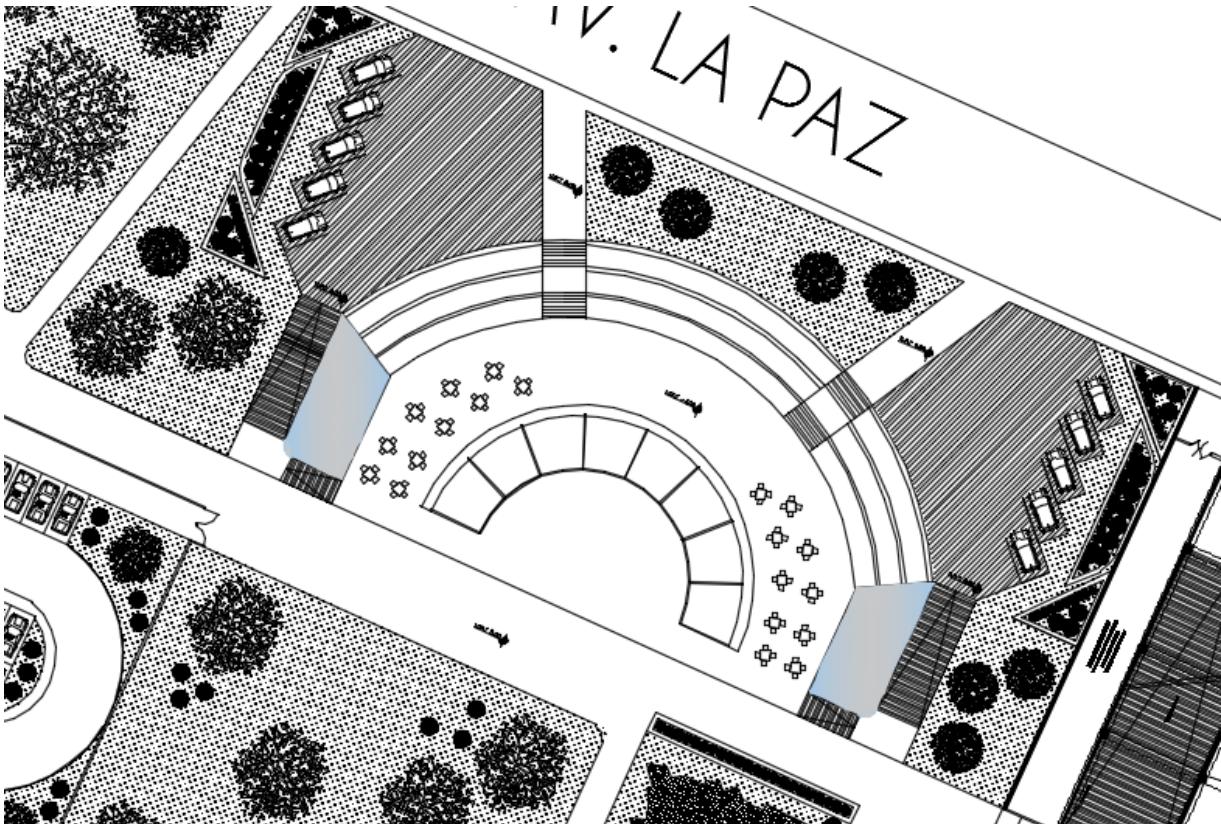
Plaza de comidas del conjunto ÁLMAR 1800 - Fuente: Propia
